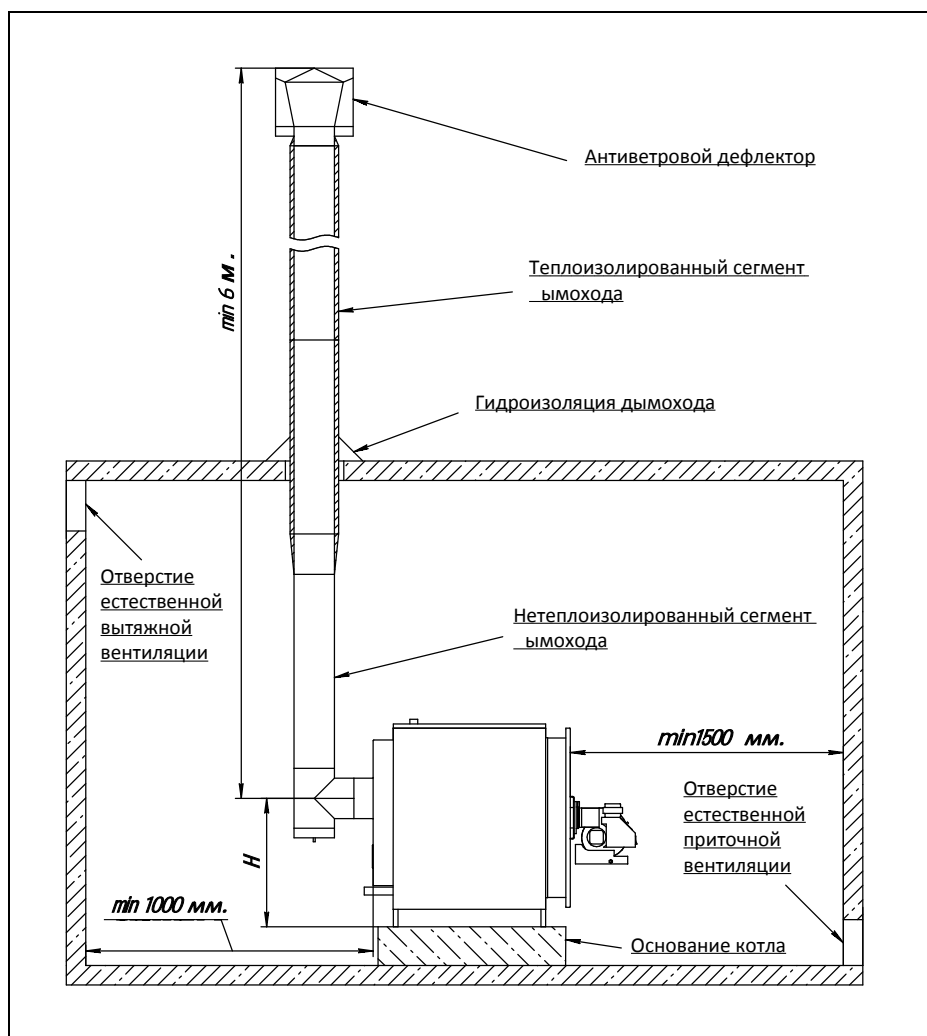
Пример установки вытяжной трубы проходящей через крышу
